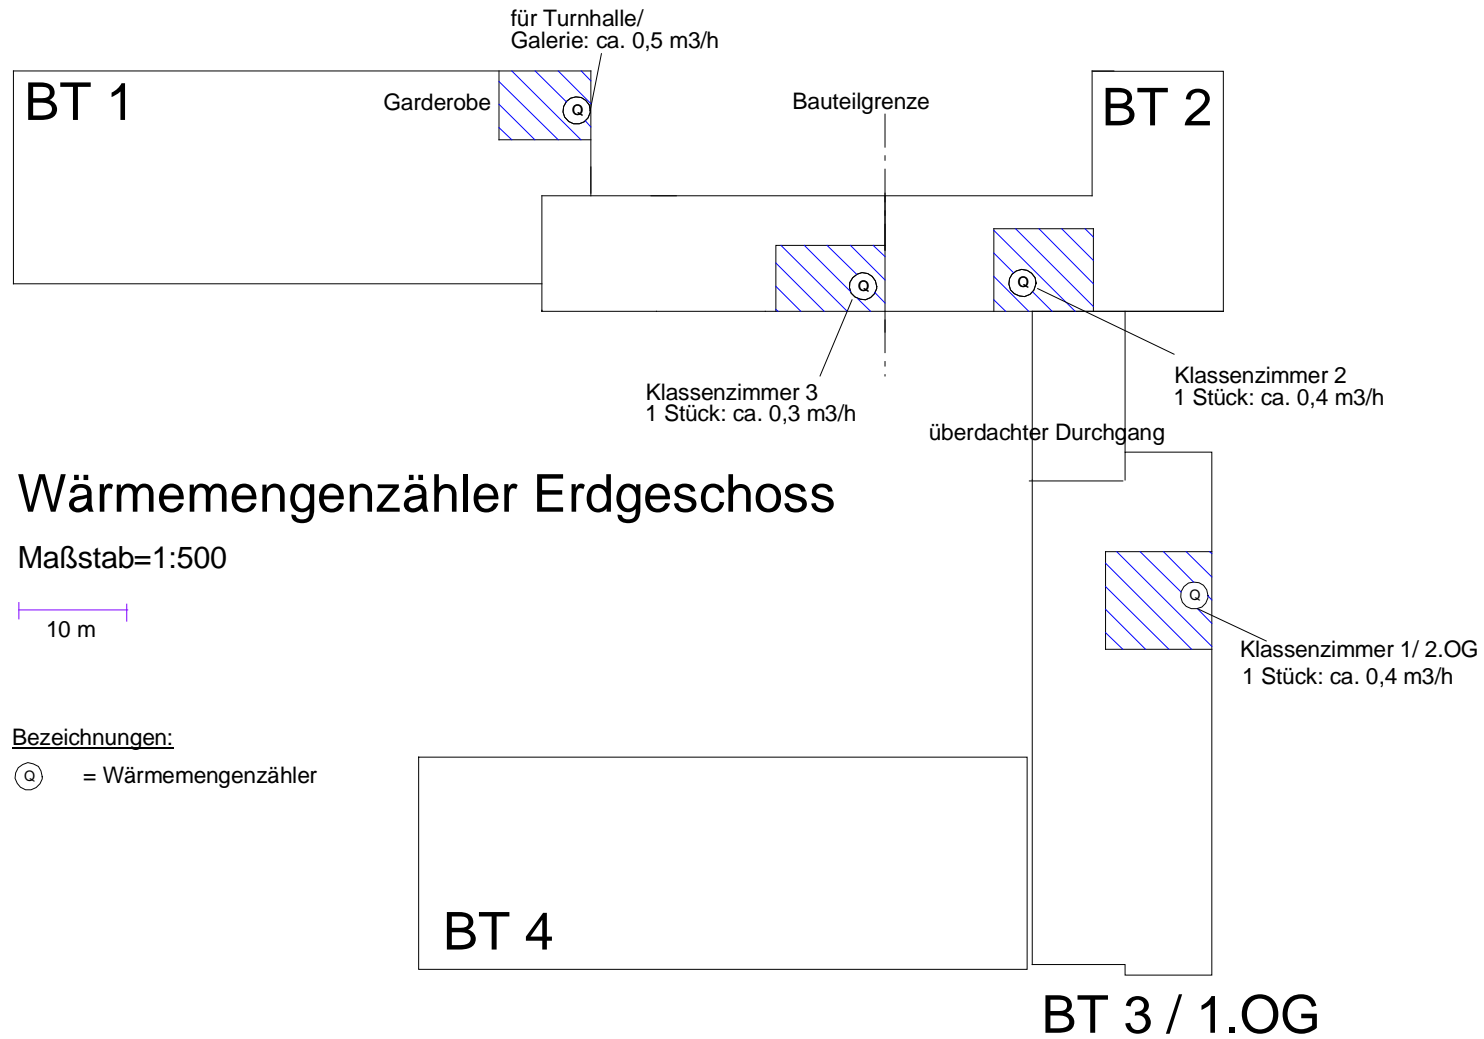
Einbauort der Wärmezähler im Erdgeschoss
